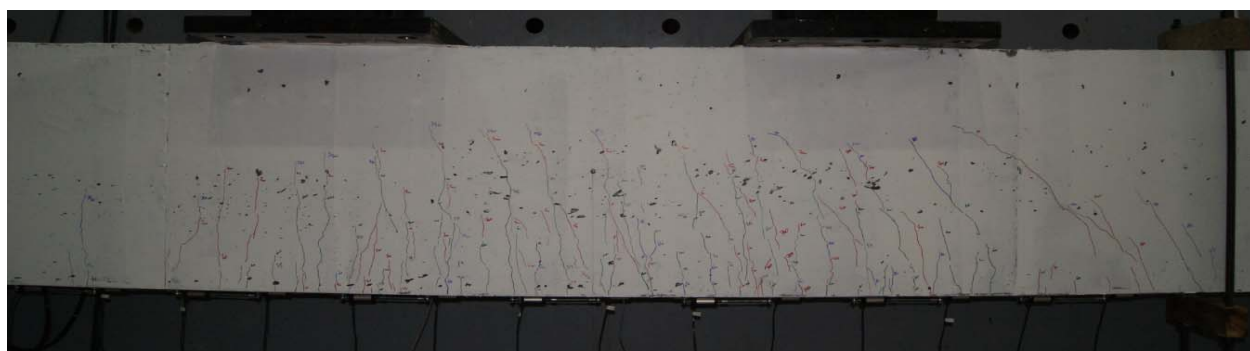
R04 - Vue d'ensemble du relevé des fissures
